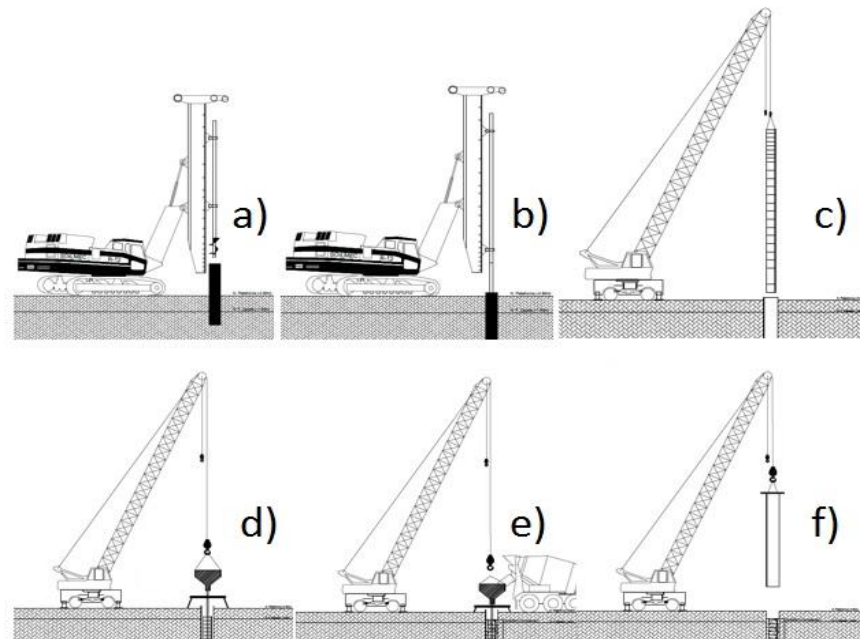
Proceso constructivo de pilote encamisado: a) Posicionamiento de la maquinaria, b) Perforación del terreno, c) Colocación de armadura, d) Instalación de tubería tremie, e) Vaciado de concreto, f) Retiro de instrumentos (PSV Constructores, 2013)
